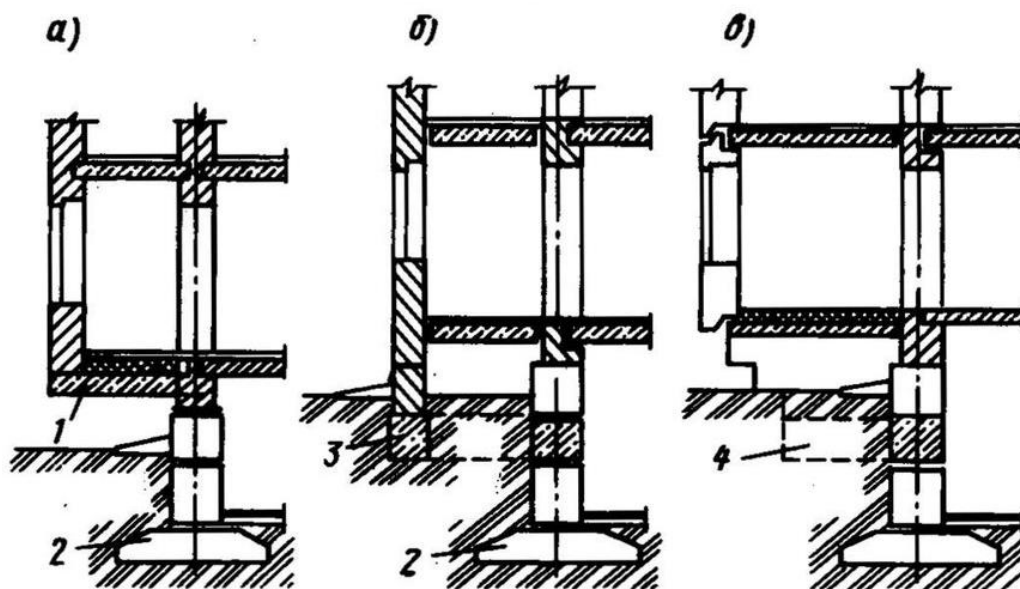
Пристройки к зданию с опиранием на консольную плиту (а), консольную раму (б) и консольную балку (в). 1- консольная плита, 2- фундамент основного здания, 3- консольная рама, 4- консольная балка
